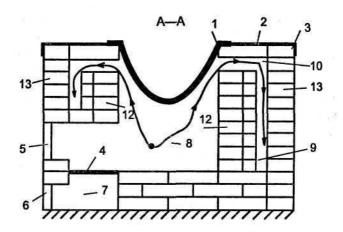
Устройство печи-топливника для установки азиатского казана, разрез А — А:
